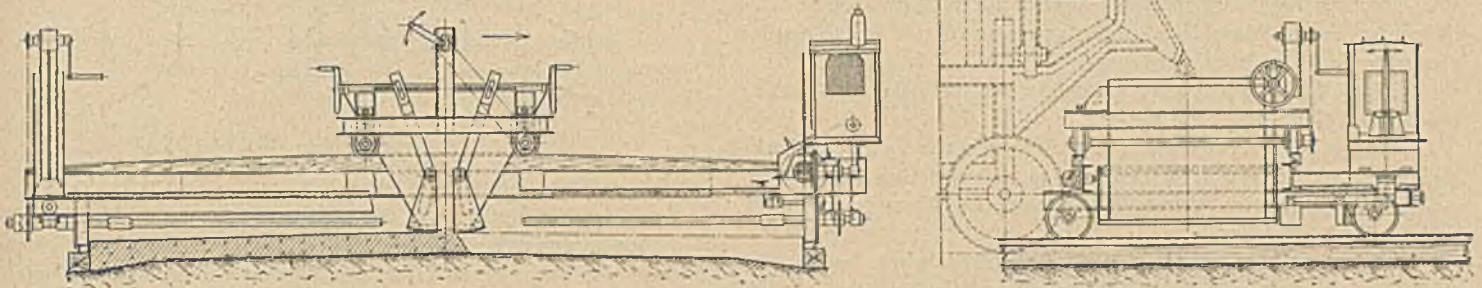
Beton-Verteilungswagen der Dinglerschen Maschinenfabrik A.-G., Zweibrücken.
